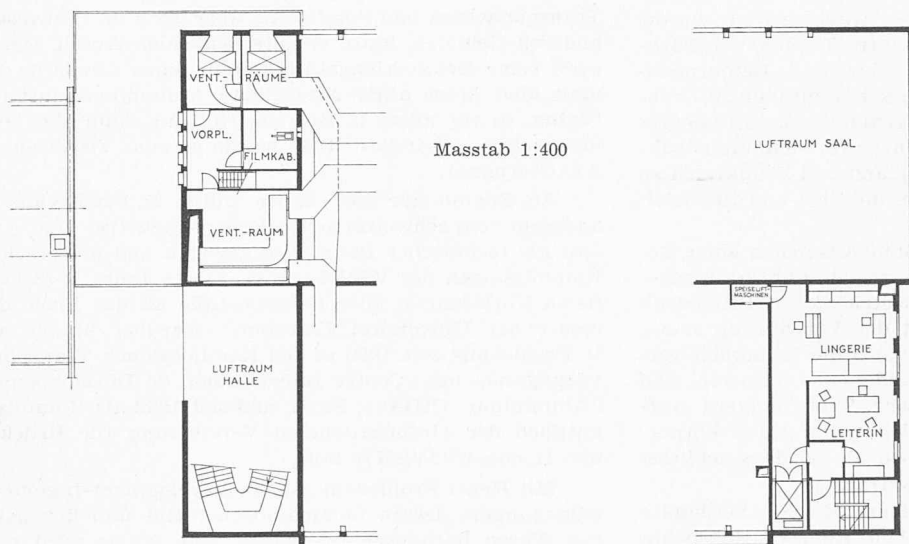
Grundriss 2. Zwischengeschoss
